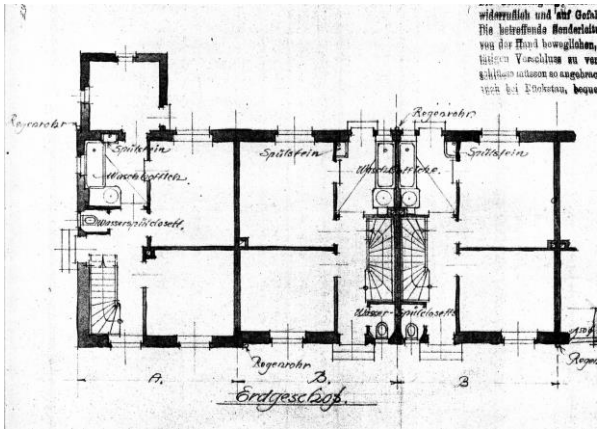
Grundriss Erdgeschoss, Typ A bzw. A_I (l.), Typ B (r.)
